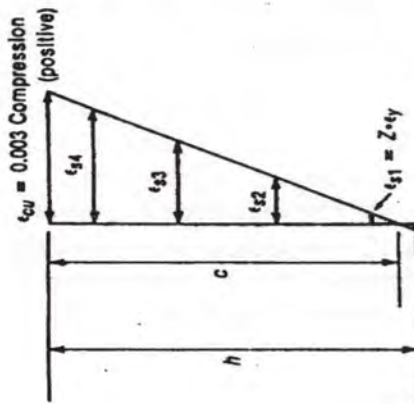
Hubungan P - M pada keruntuhan kolom beton bertulang
